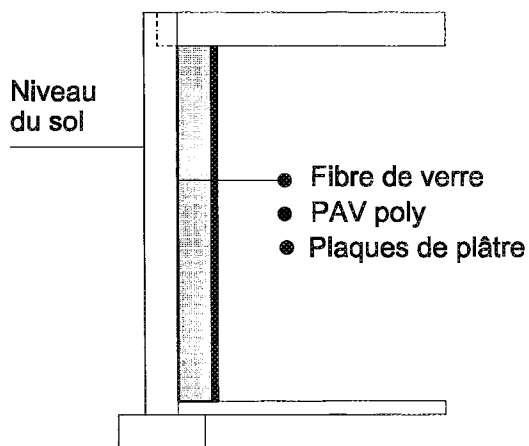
Panneau d'essai 1 – Mur ordinaire et PAV derrière les plaques de plâtre.
